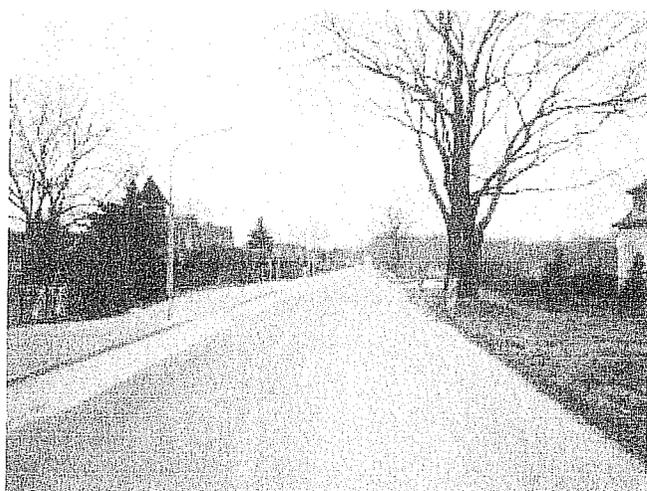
Blick nach Westen auf die Ludwig-Jahn-Straße mit den beiden Straßenbäumen
